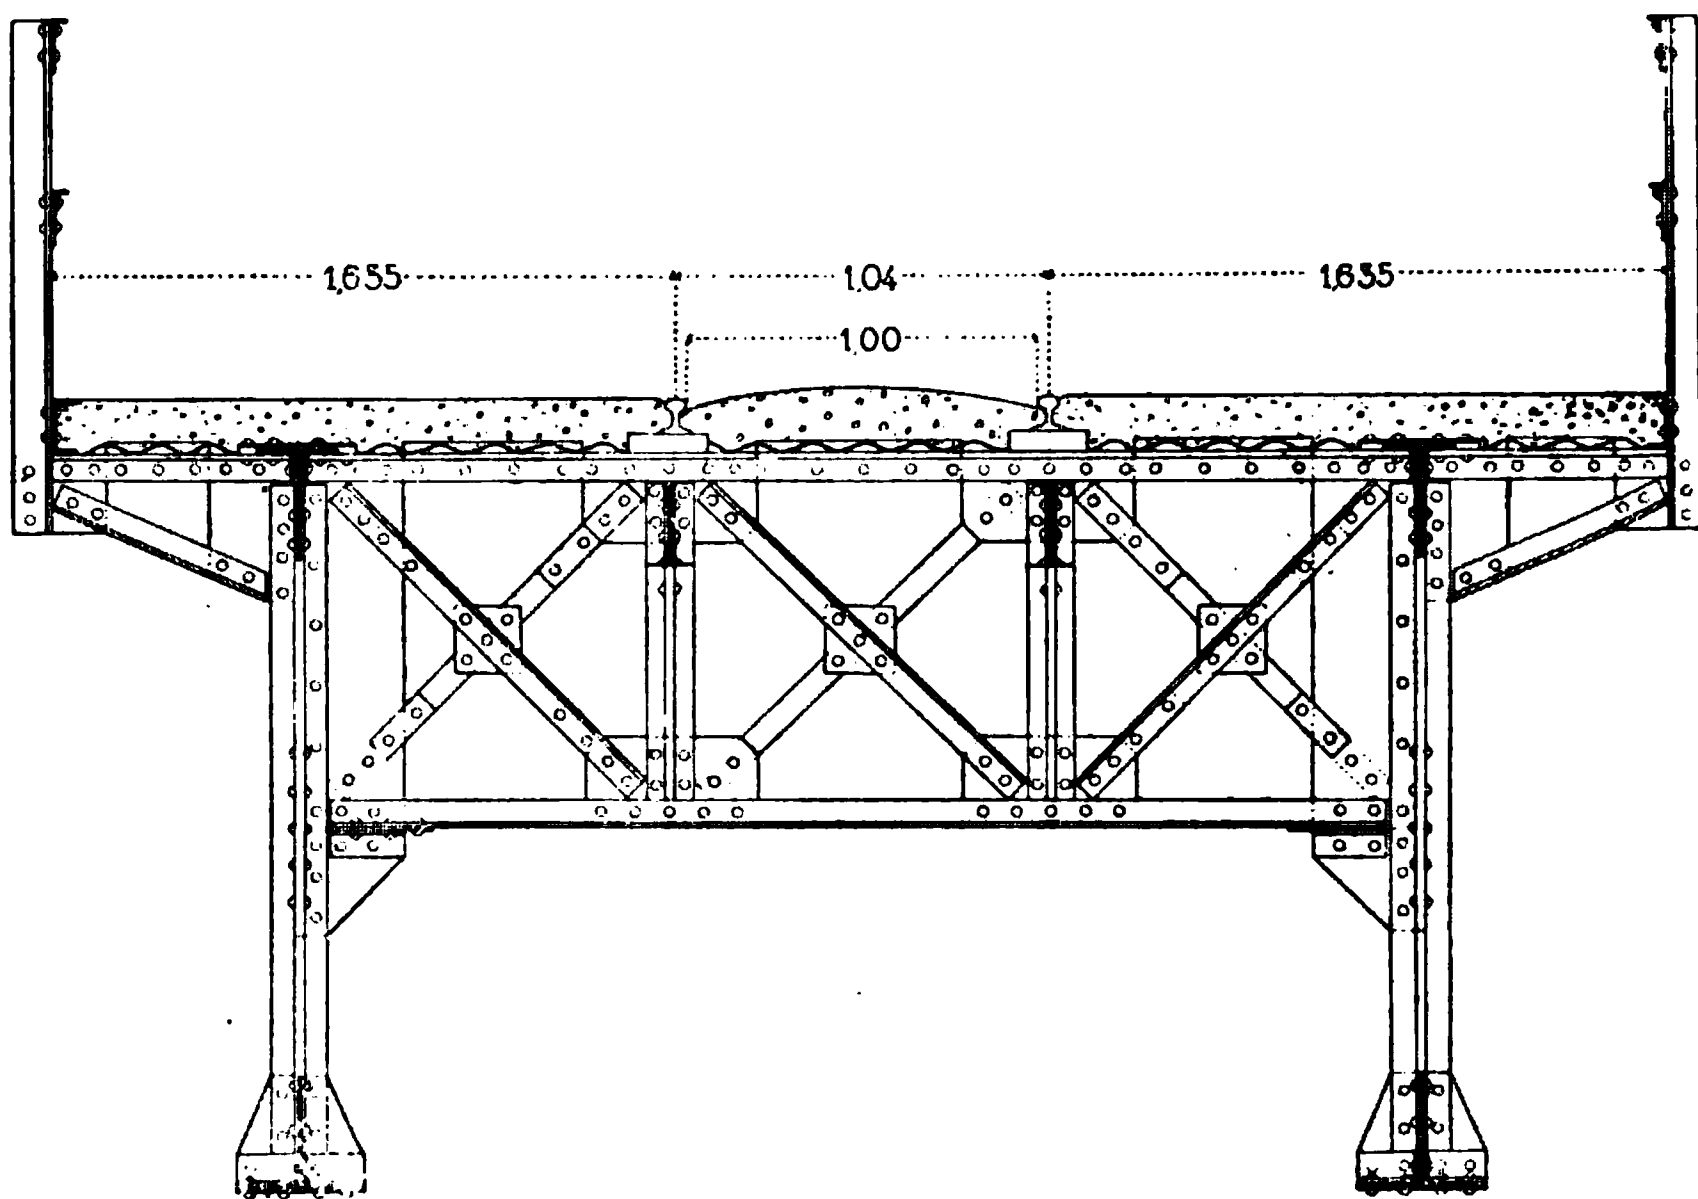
Pont de Mahina. Section verticale d'une travée (1/40).
